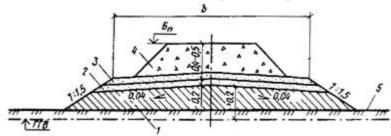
Конструкция насыпи с гидроизоляционными песчаными слоями на основной площадке земляного полотна
